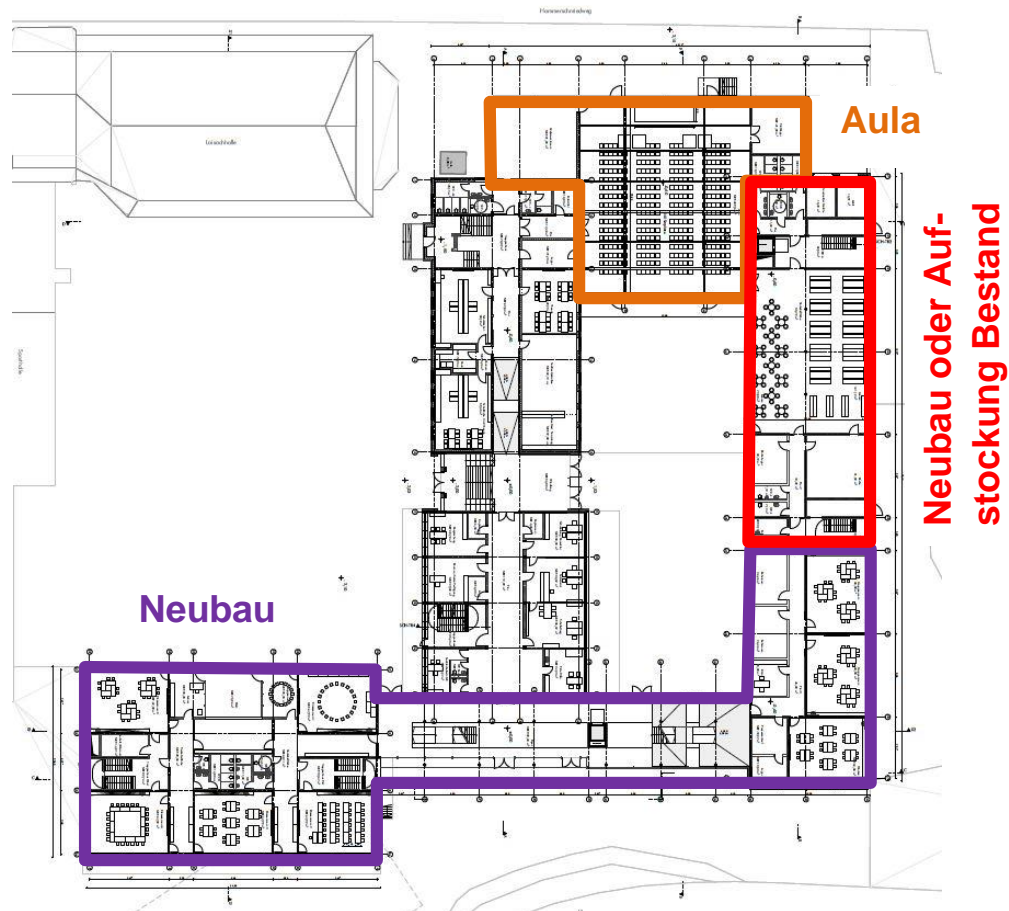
Grundriss Erdgeschoss Planung: karlundp vom August 2019, ohne Maßstab
